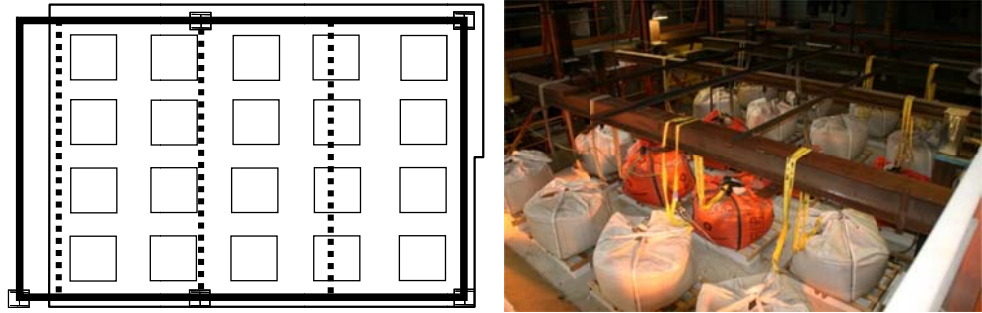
Conditions de chargement du plancher mixte acier béton exposé au feu
